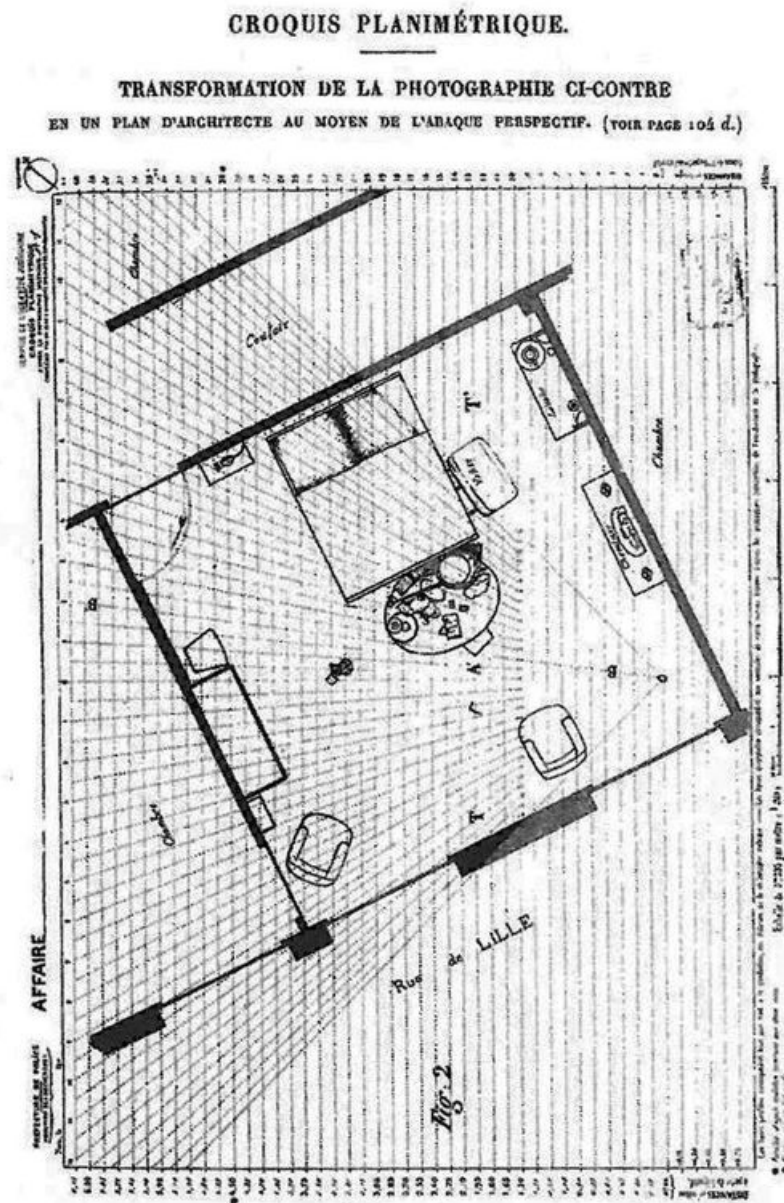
Croquis planimétrique, transformation d’une photographie en un plan d’architecte au moyen de l’abaque perspectif.⁴⁰⁶¹
